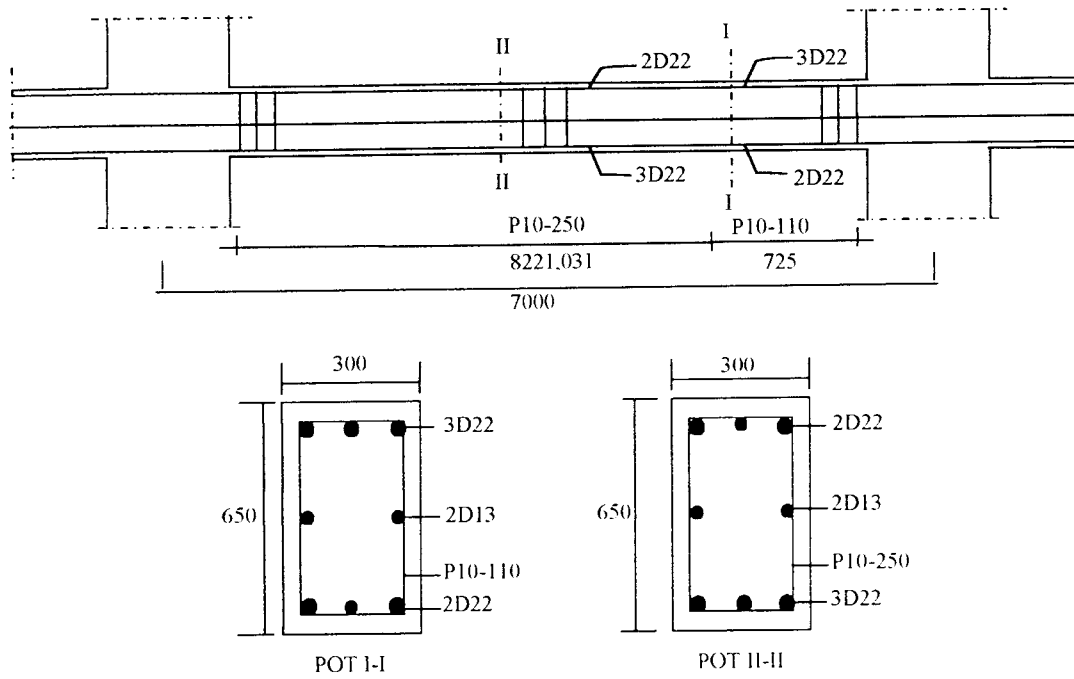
Balok Portal E Bentang 7m Lantai 10
